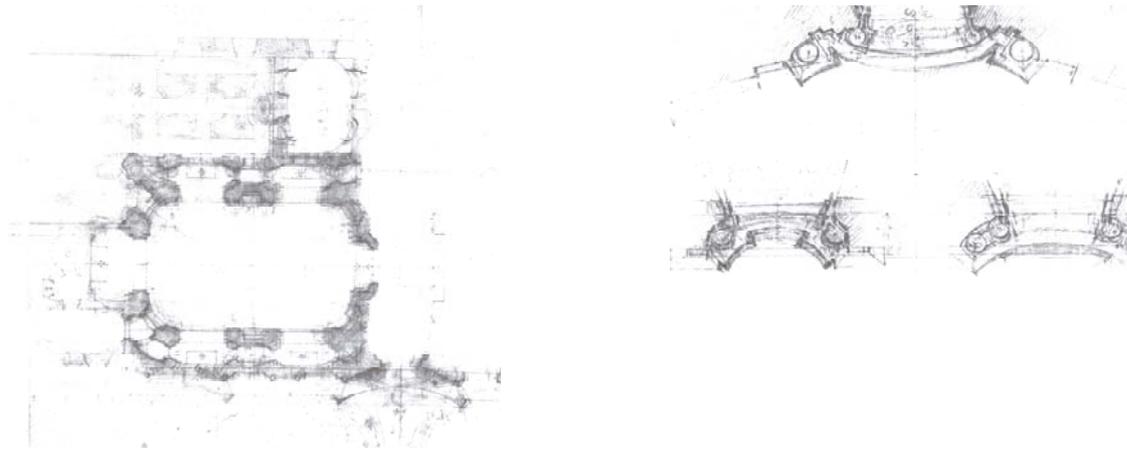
F. Borromini, Grundriss der Dreikönigskapelle des Collegio di Propaganda Fide in Rom und Detail der Fenstergesimse der Hauptfassade, 1642
